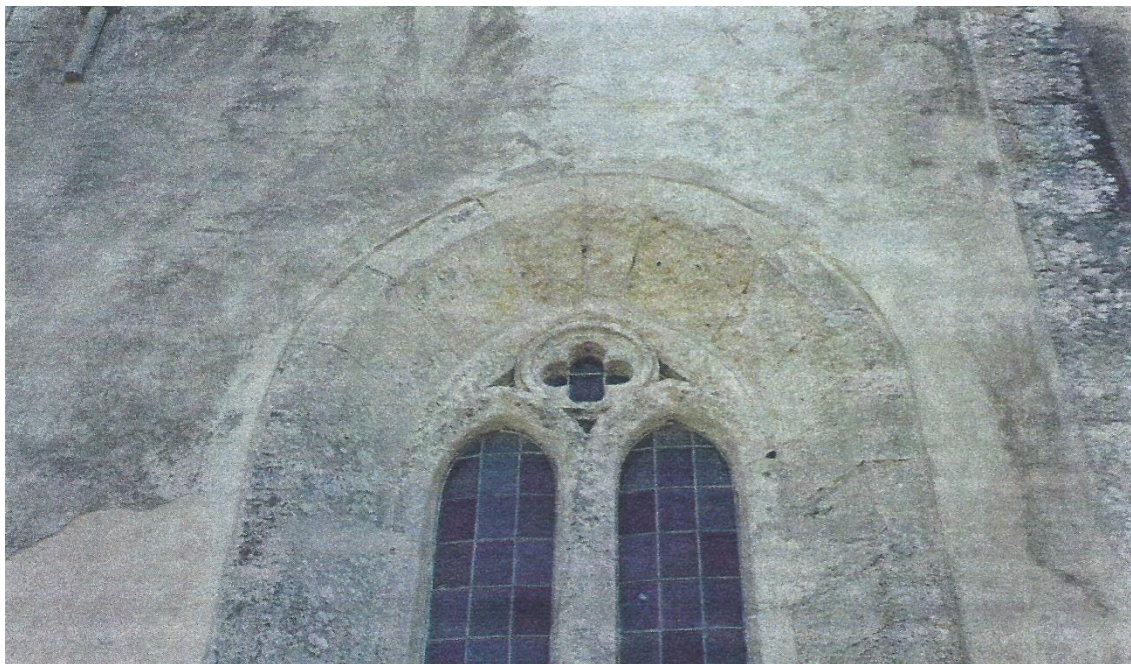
Janela da Capela – Fachada Norte (1994)
